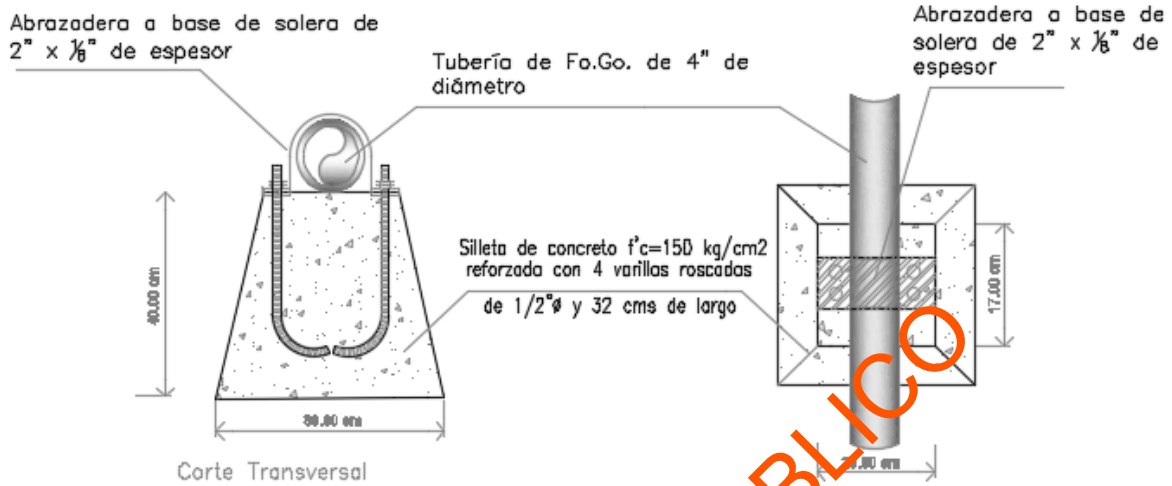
Detalle de la ubicación de la silleta en el nodo 22
